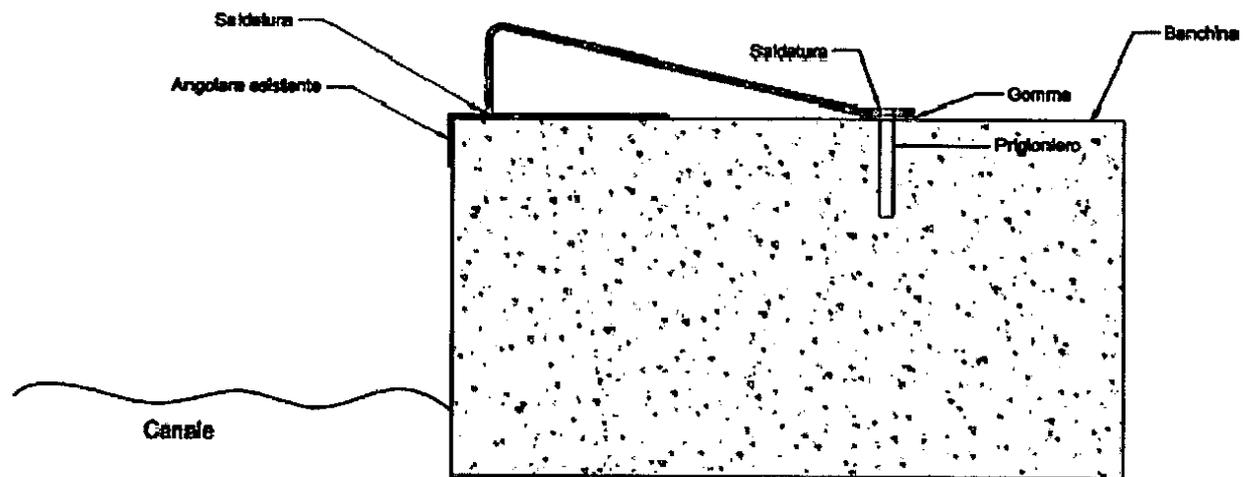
Sezione della lamiera di contenimento installata sul filo banchina
